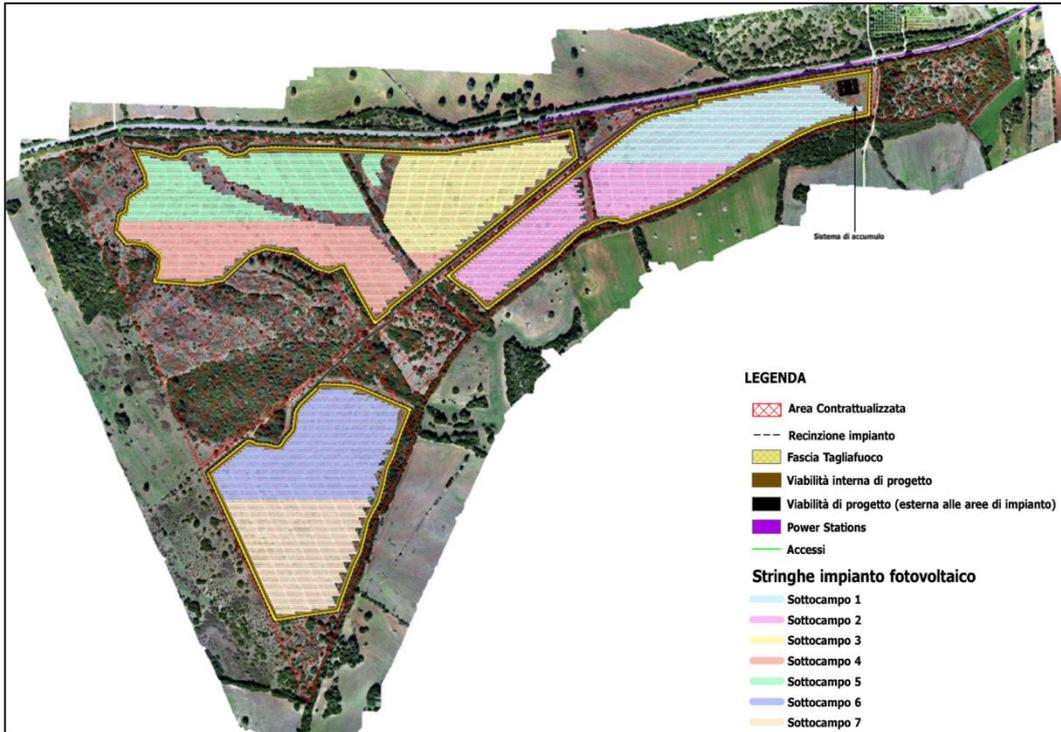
Dettaglio suddivisione in sottocampi (estratto di PRO\_TAV\_8).
